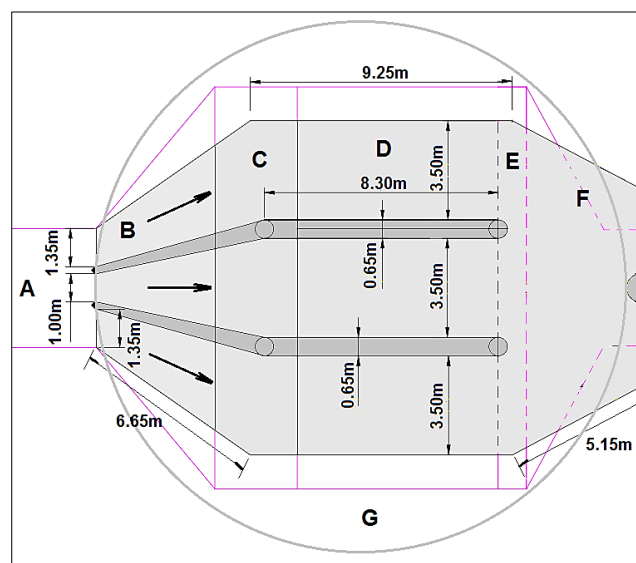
Planta de la geometría del pozo de cribado usada en el modelo.
